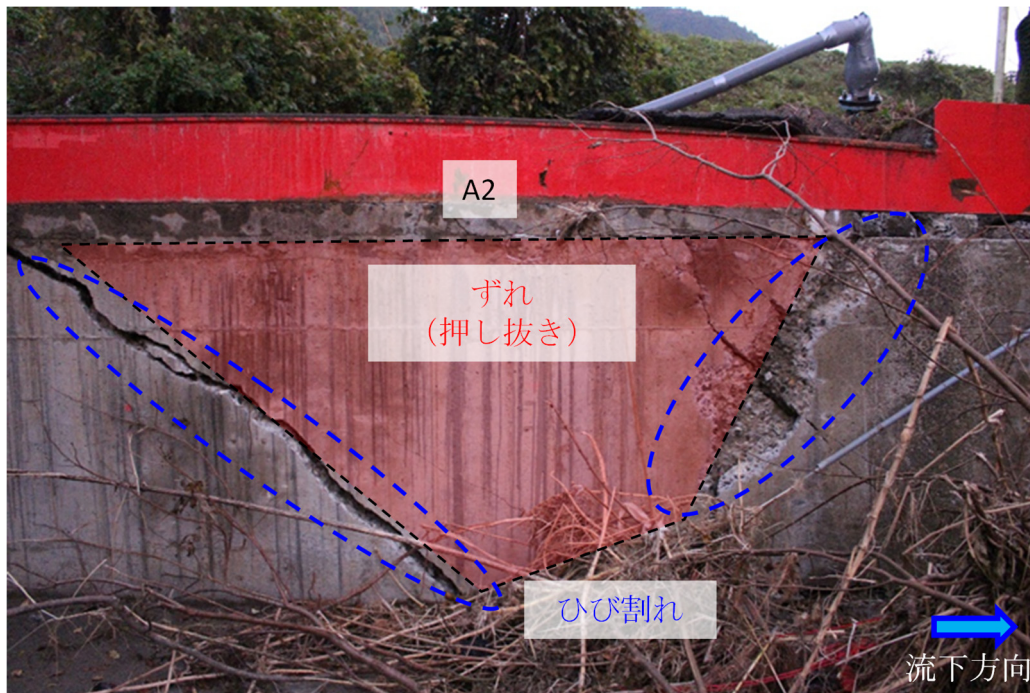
A2 橋台パラペットのひび割れ (10月30日)
